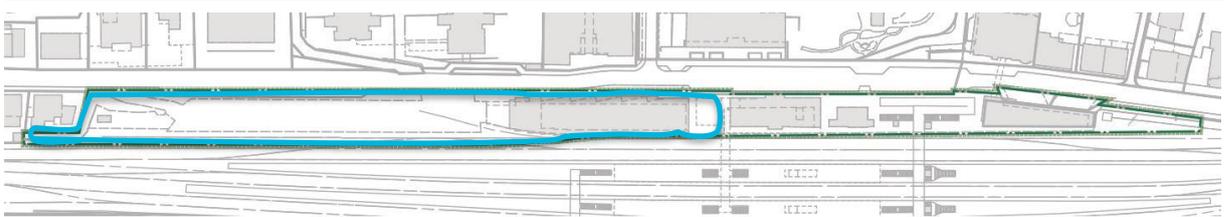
Gestaltungsplanperimeter (blau) mit einer Fläche von 5'880 m² und Betrachtungsperimeter (grün) mit einer massgeblichen Grundfläche von rund 8'800 m²
